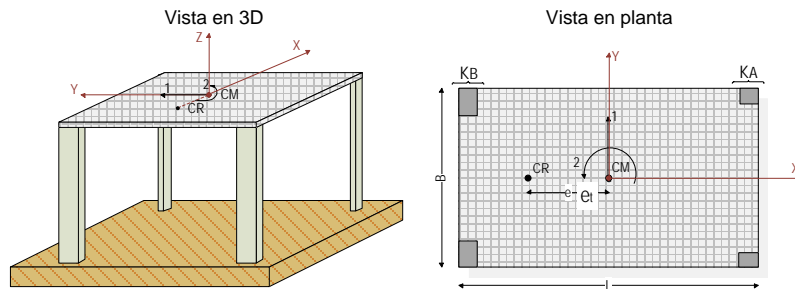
Vista tridimensional y en planta del modelo torsional sin AMS
